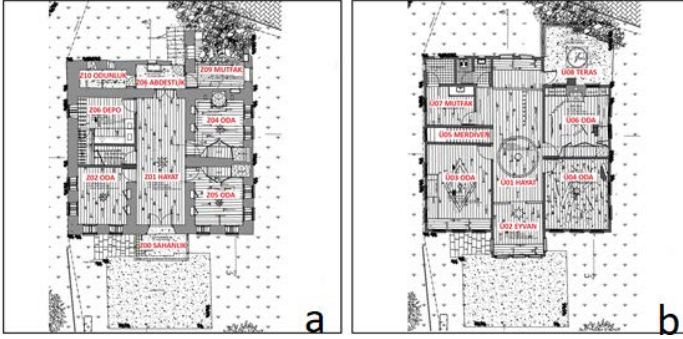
a--Eray Erdem Evi Rölöve Vaziyet Planı; 5.b- Bodrum Kat Rölöve Planı
